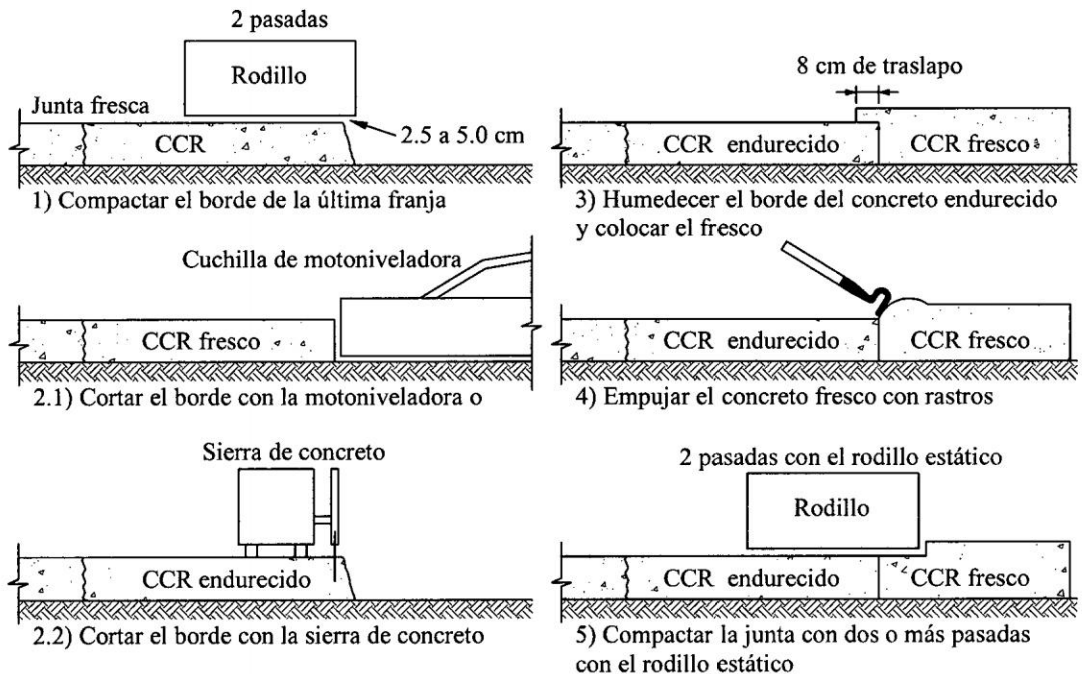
Construcción de juntas frías. (Fuente: Londoño (1988)[15], ACI 325.10R (2001)[2])
